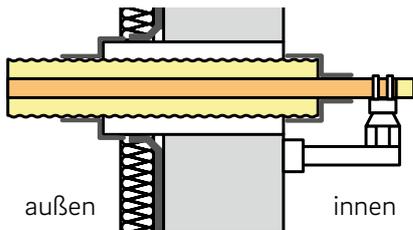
Einbauschema Stützhülse mit angerauter Oberfläche
